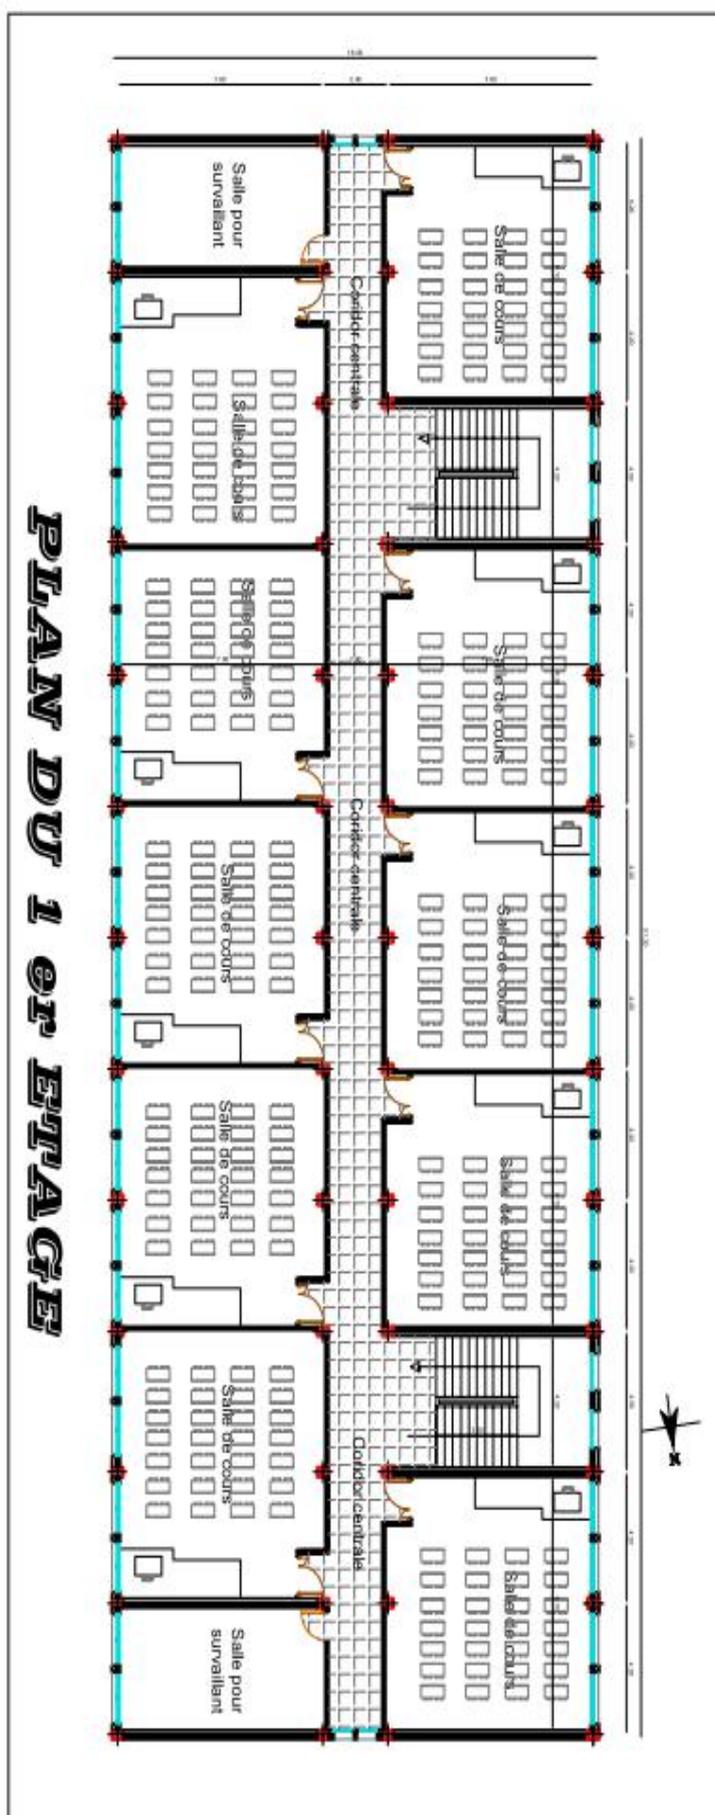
plan de 1^{er} étage du CEM Base 07.
